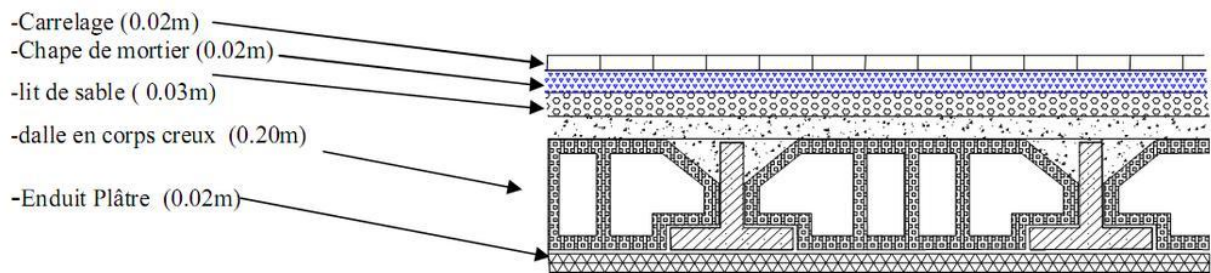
Composant d'un plancher terrasse inaccessible
